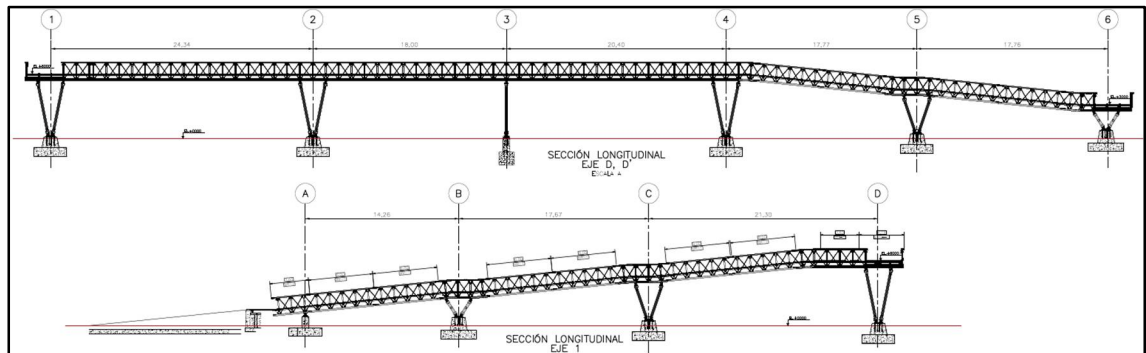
Vista en planta y perfil del puente peatonal sobre la Av.NQS
